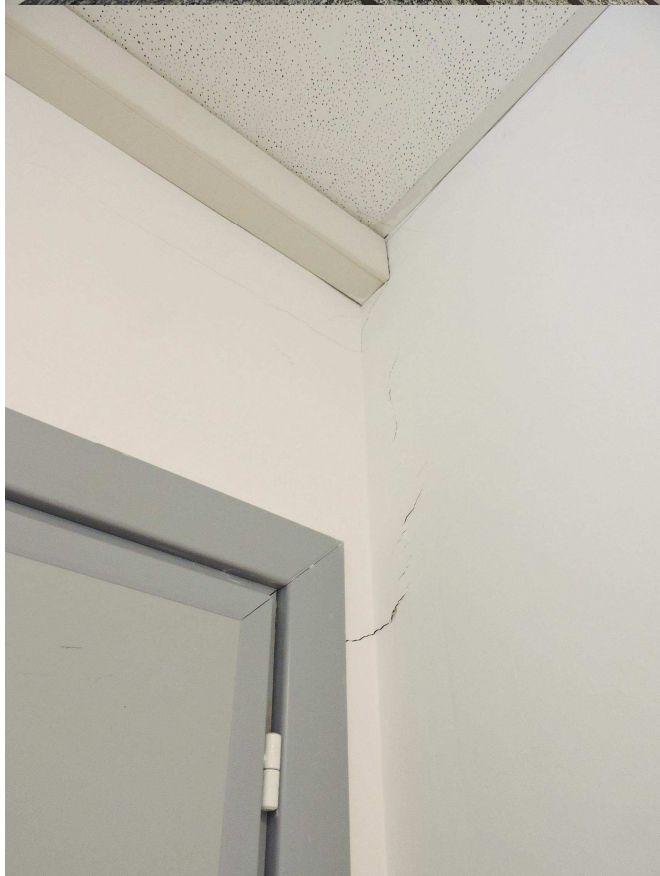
Cavillatura superficiale dell'intonaco nell'aula "bar scolastico", piano secondo, in prossimità della porta interna di accesso.
